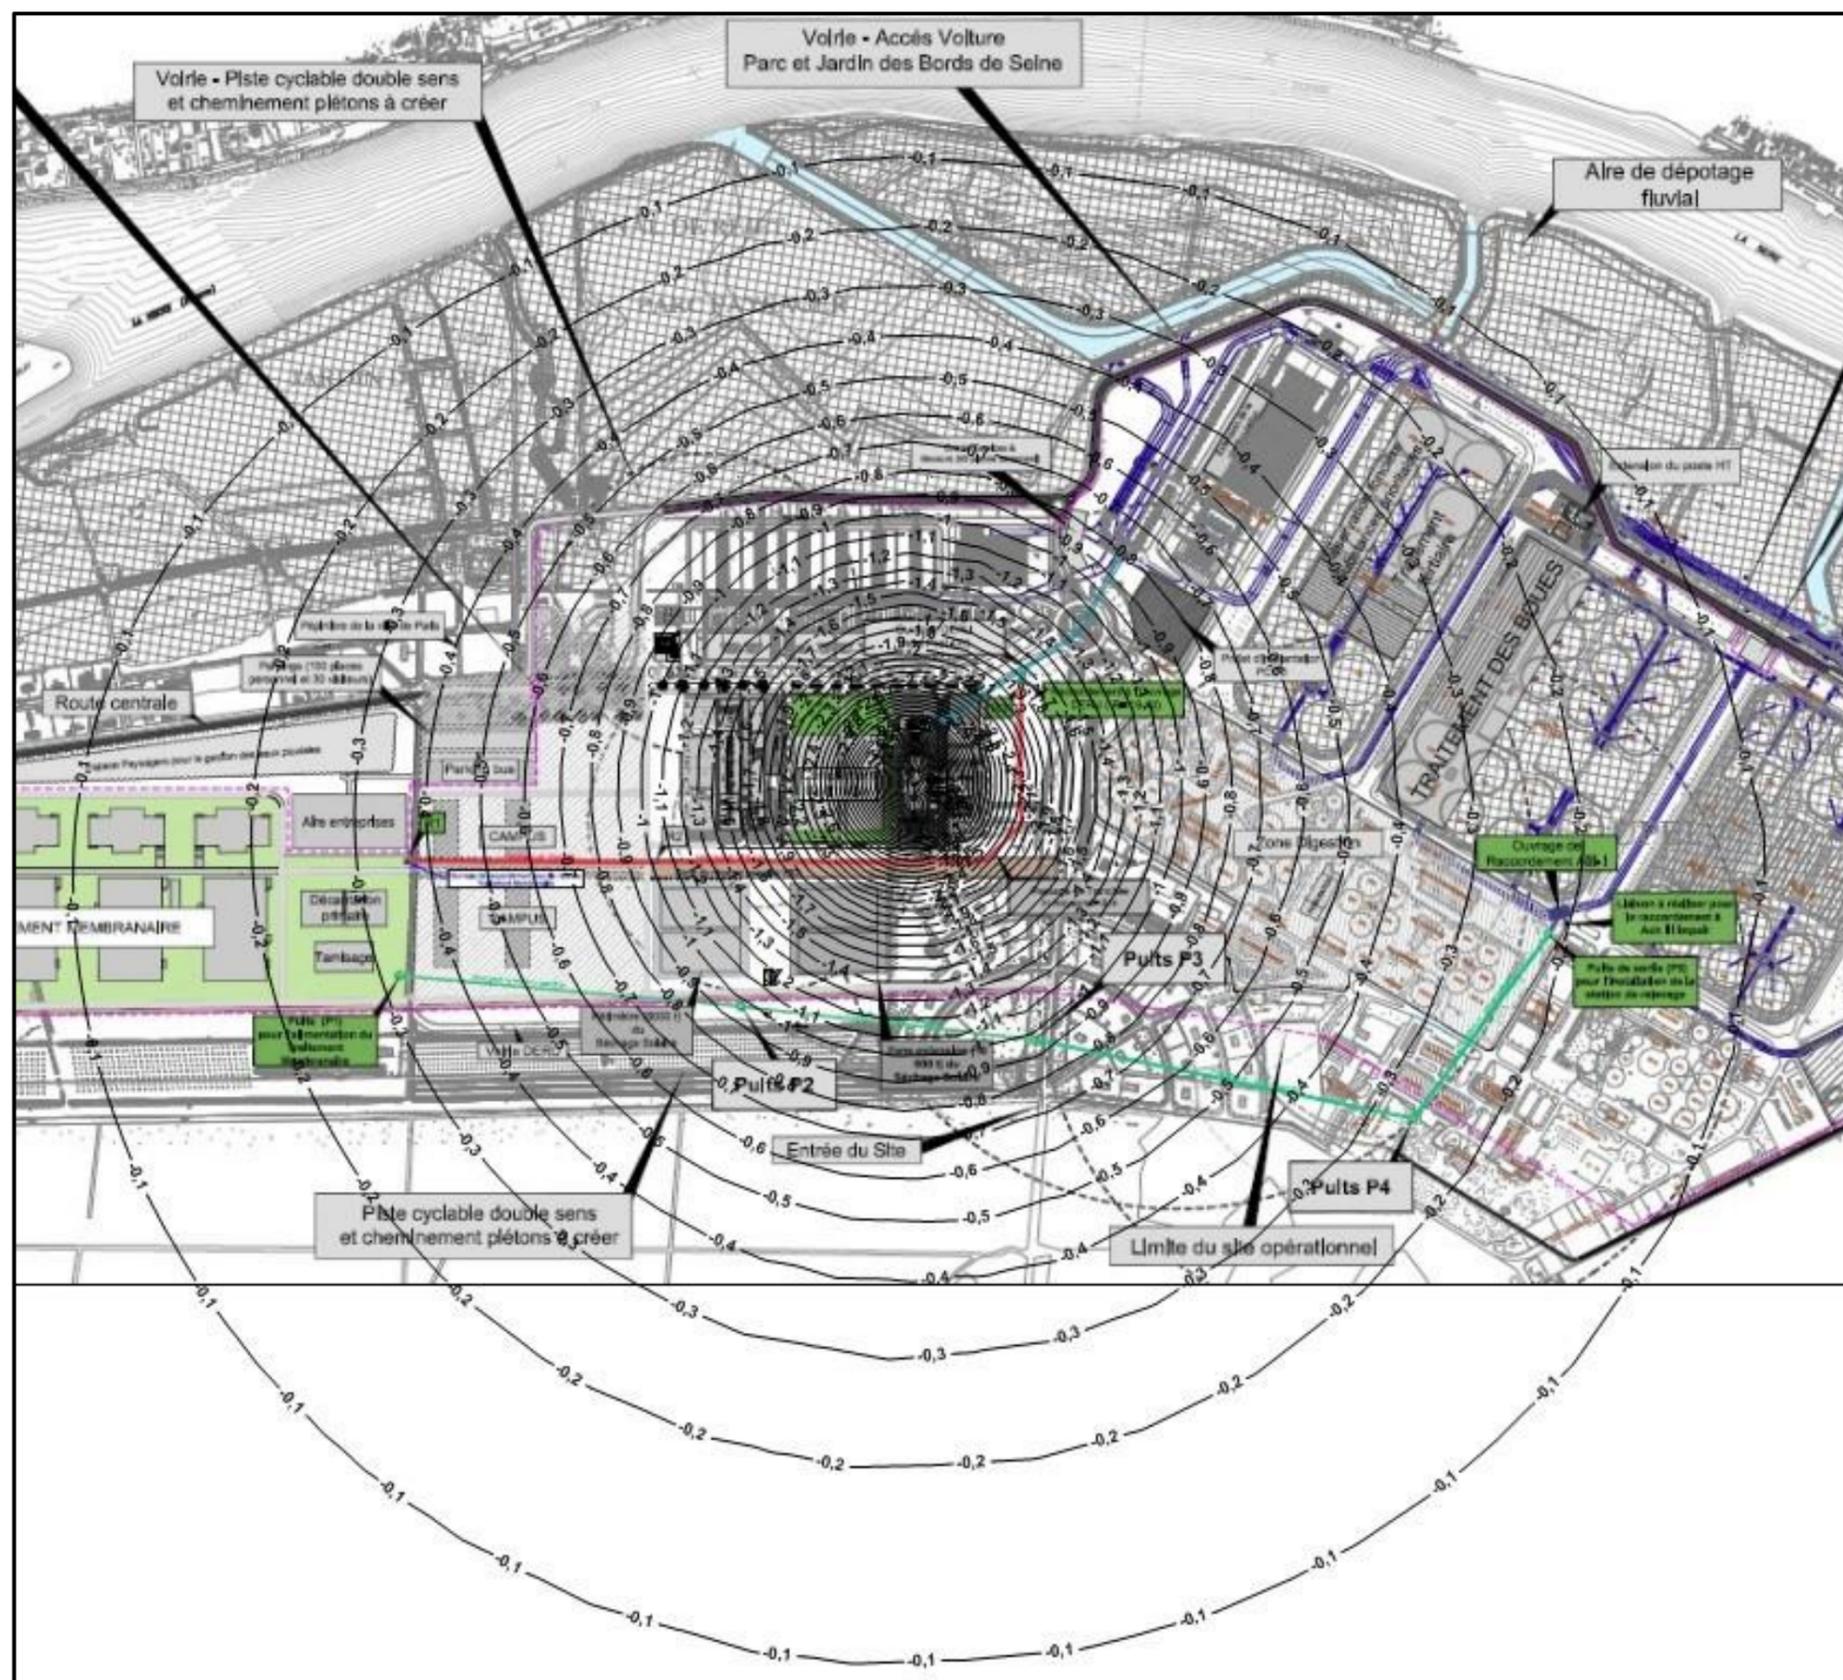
Modélisation du rabattement de nappe projeté sur le plan aérien du futur ouvrage.
